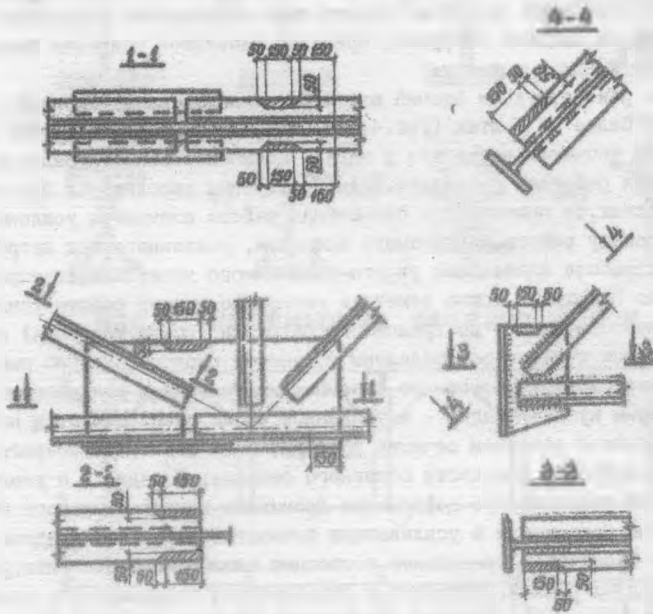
Пример вырезки и размеры заготовок плоских образцов для испытания металла ферм.
